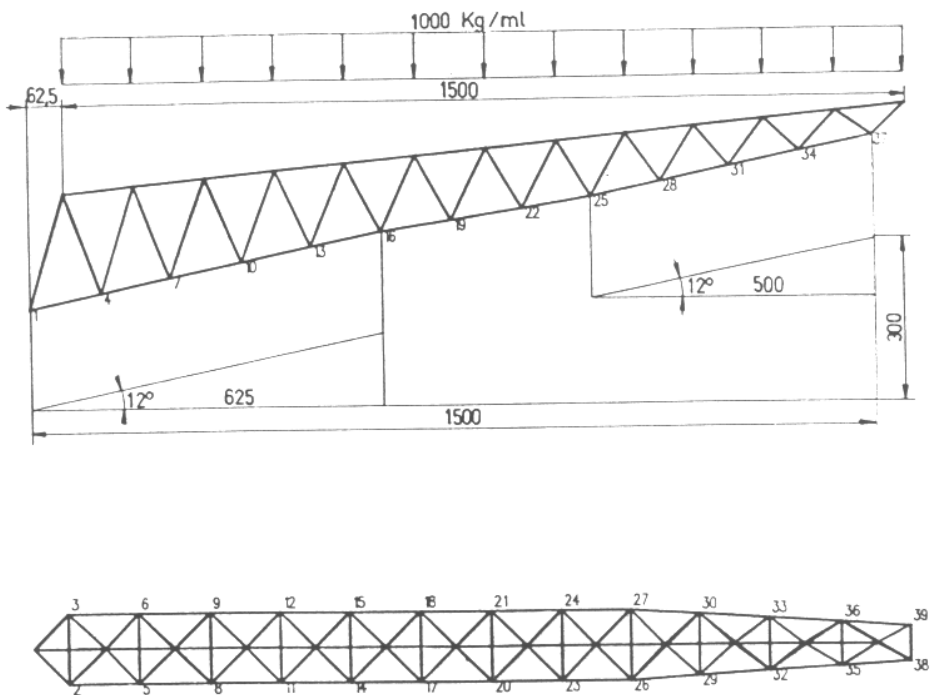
Ménsula espacial de nudos articulados. Nudos en alzado y planta.
